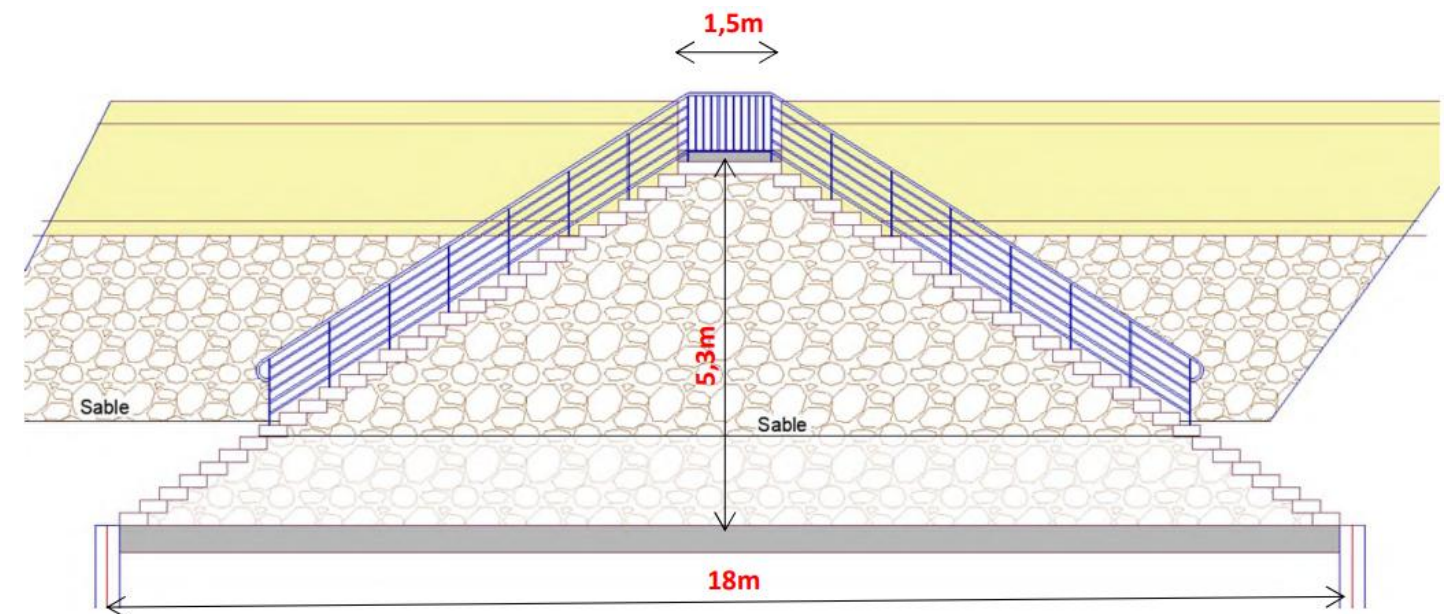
Vue en élévation de principe de l'escalier d'accès à la plage Wilson
